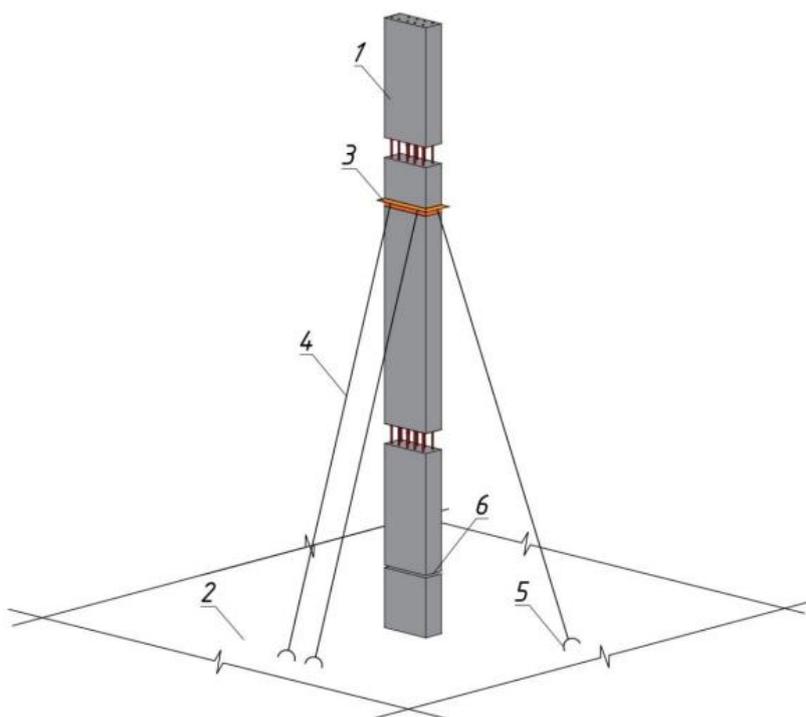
Схема монтажного закрепления элемента колонны подкосами 1 – верхняя секция пилона; 2 – ж/б перекрытие нижележащего этажа; 3 – металлический хомут – монтажная обойма с проушинами для крепления подкосов; 4 – инвентарный металлический винтовой подкос; 5 – анкеры для крепления нижней части монтажных подкосов, закрепленные на перекрытии; 6 – стык нижнего и верхнего элемента пилона (штепсельное соединение)
